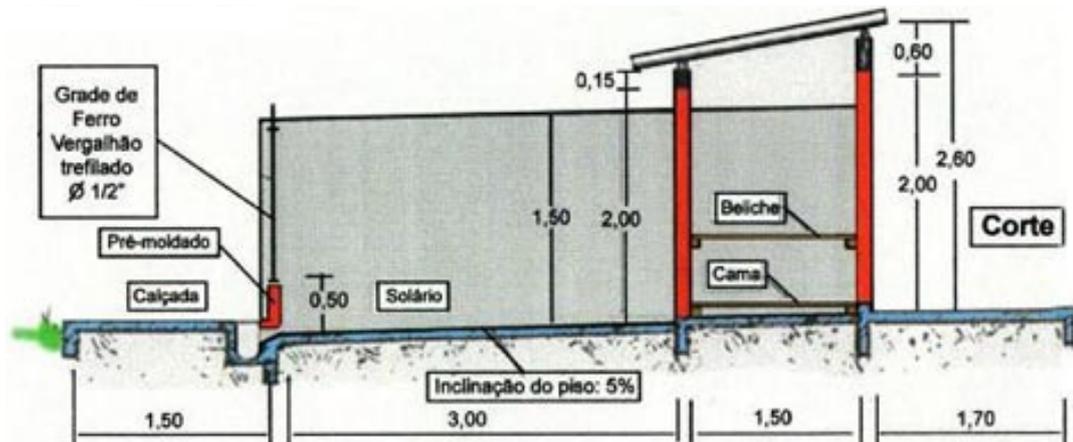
Croquis do corte esquemático - Canil ideal. Fonte: Web Animal, 2016.
